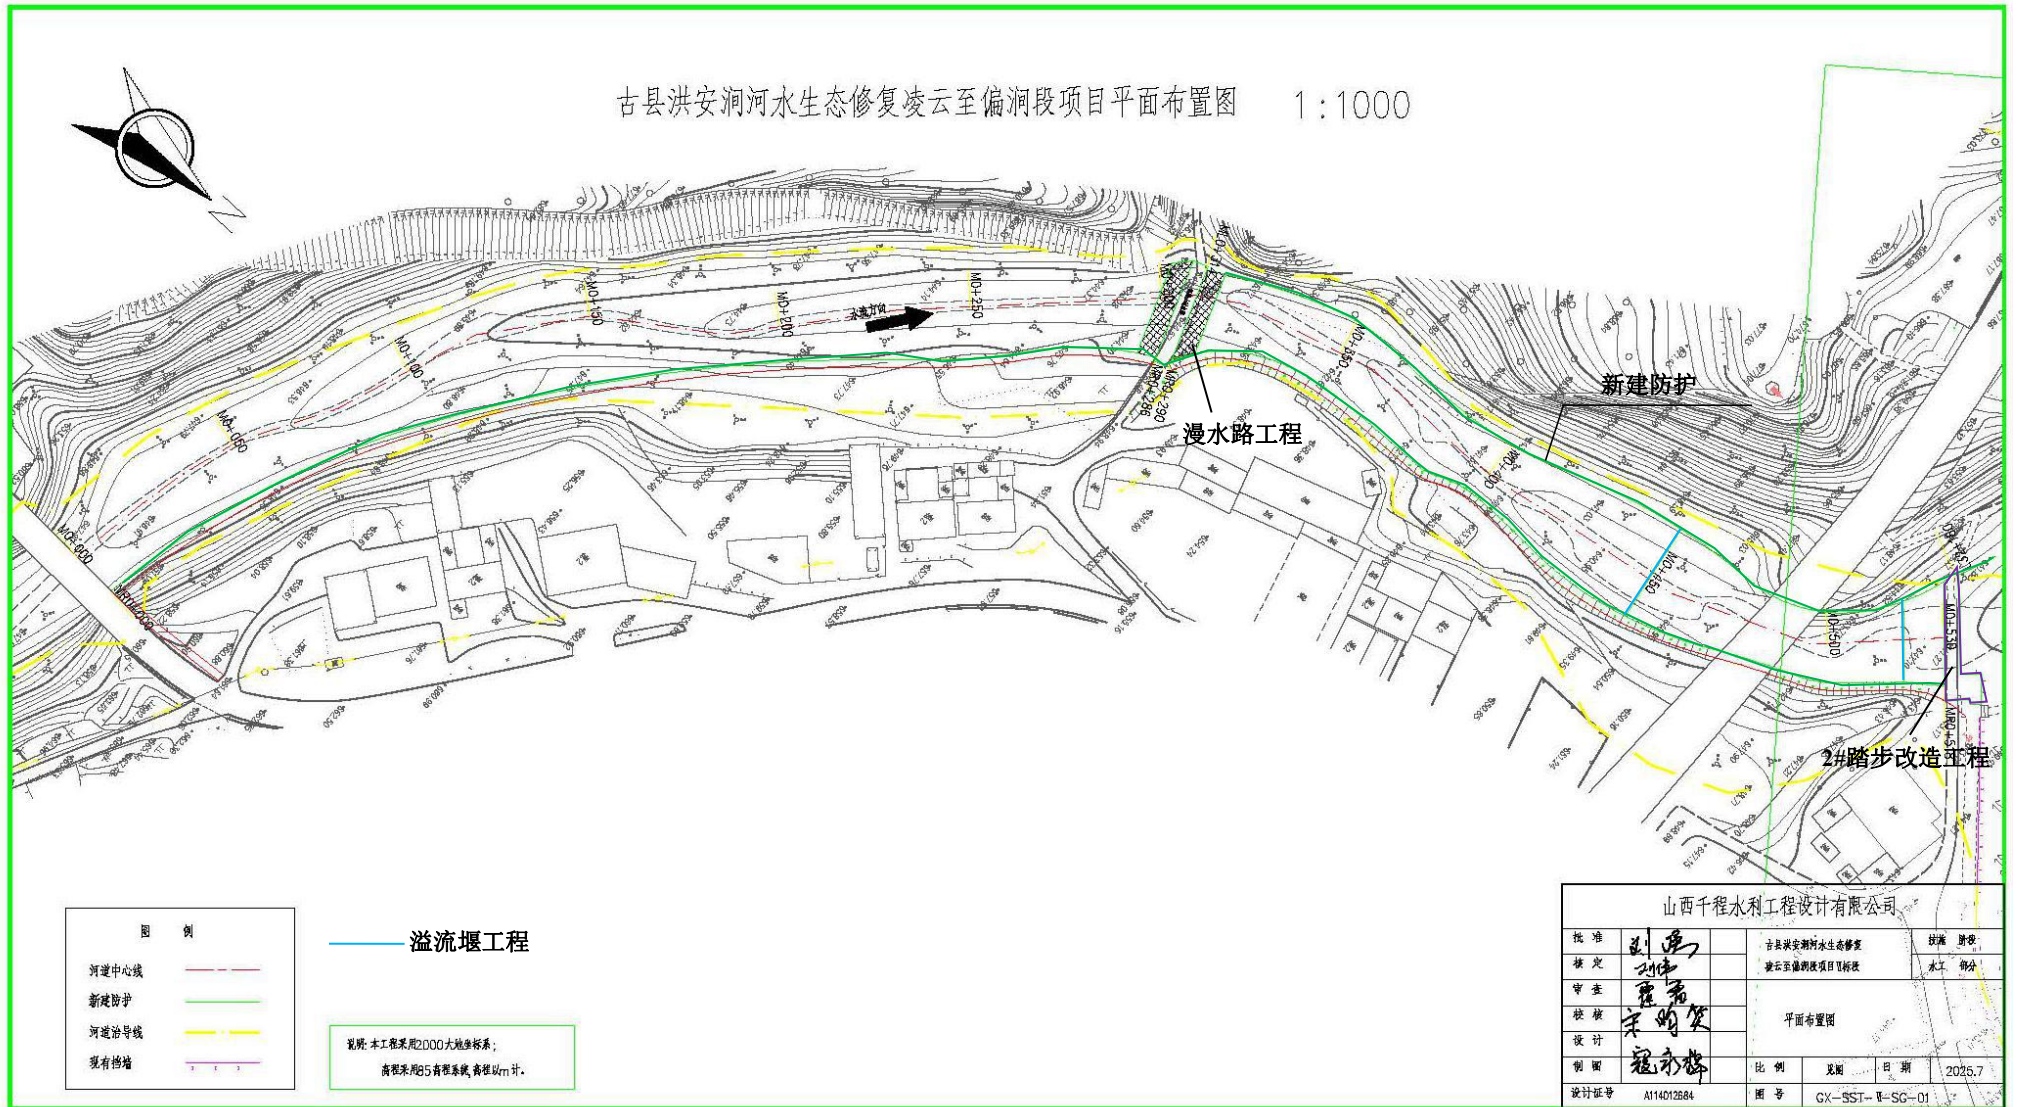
(20) 工程总平面布置图 (桩号 M0+000-M0+530)
